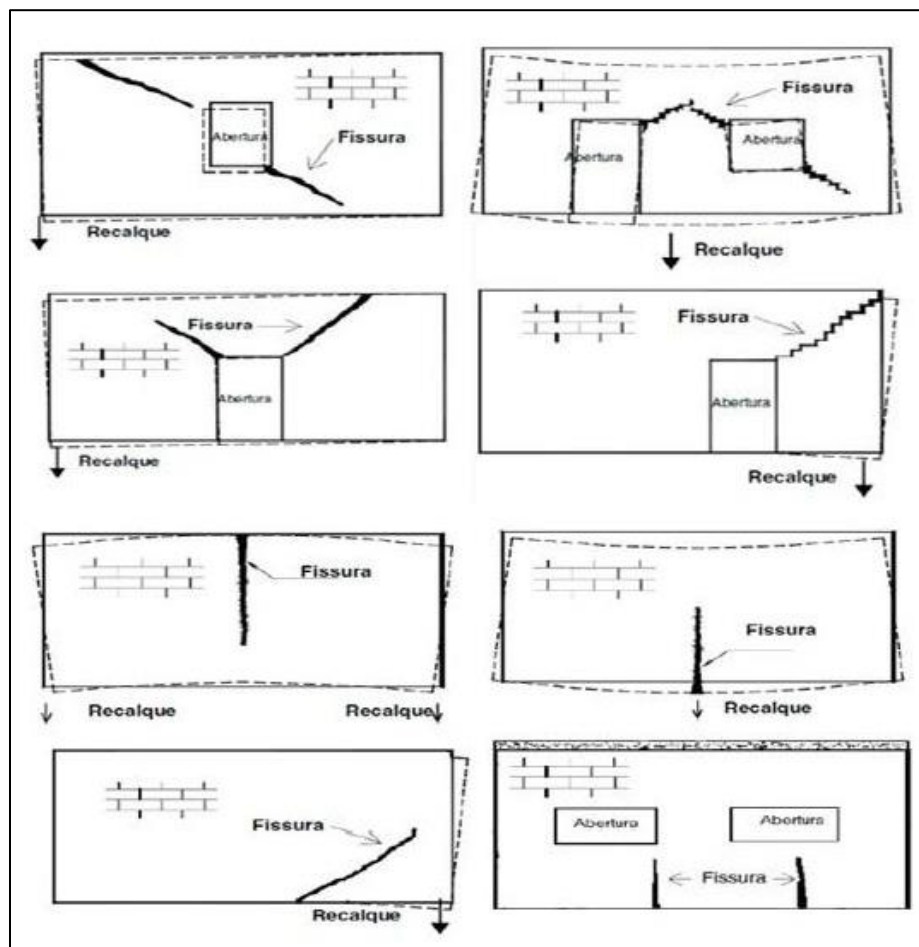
Fissuras de uma edificação oriundas de recalque de fundações em construção sobre aterro.
